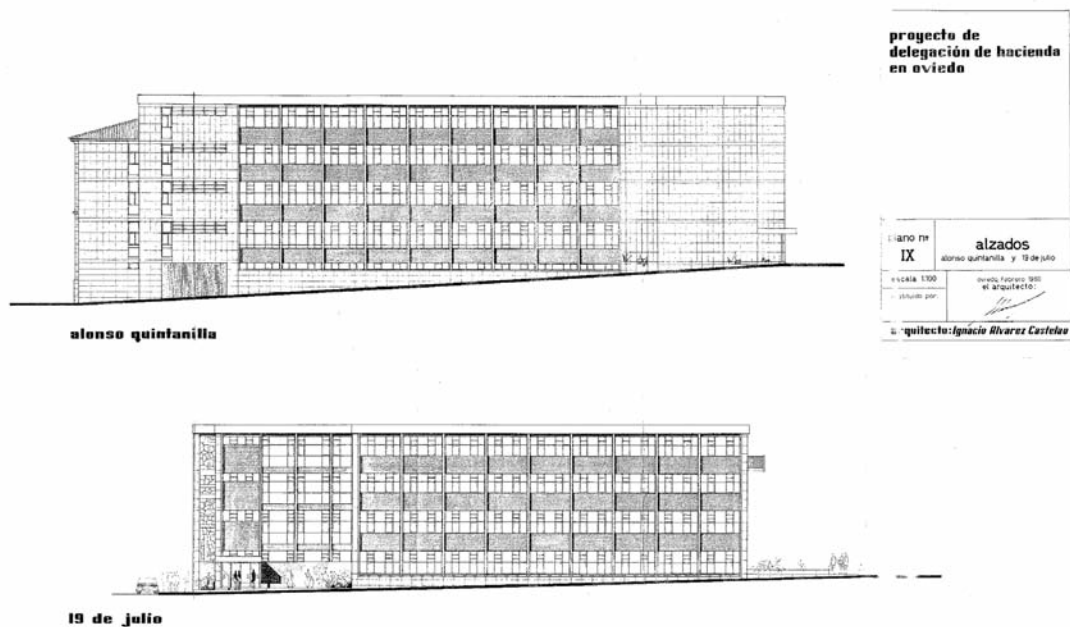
Proyecto de Delegación de Hacienda en Oviedo, 1960. Arquitecto, Ignacio Álvarez Castelao. Delineante, Antonio Trelles. Alzado Sur, a la calle Alonso Quintanilla, y alzado Oeste, a la calle 19 de Julio. (Archivo particular de la familia Álvarez Castelao).
